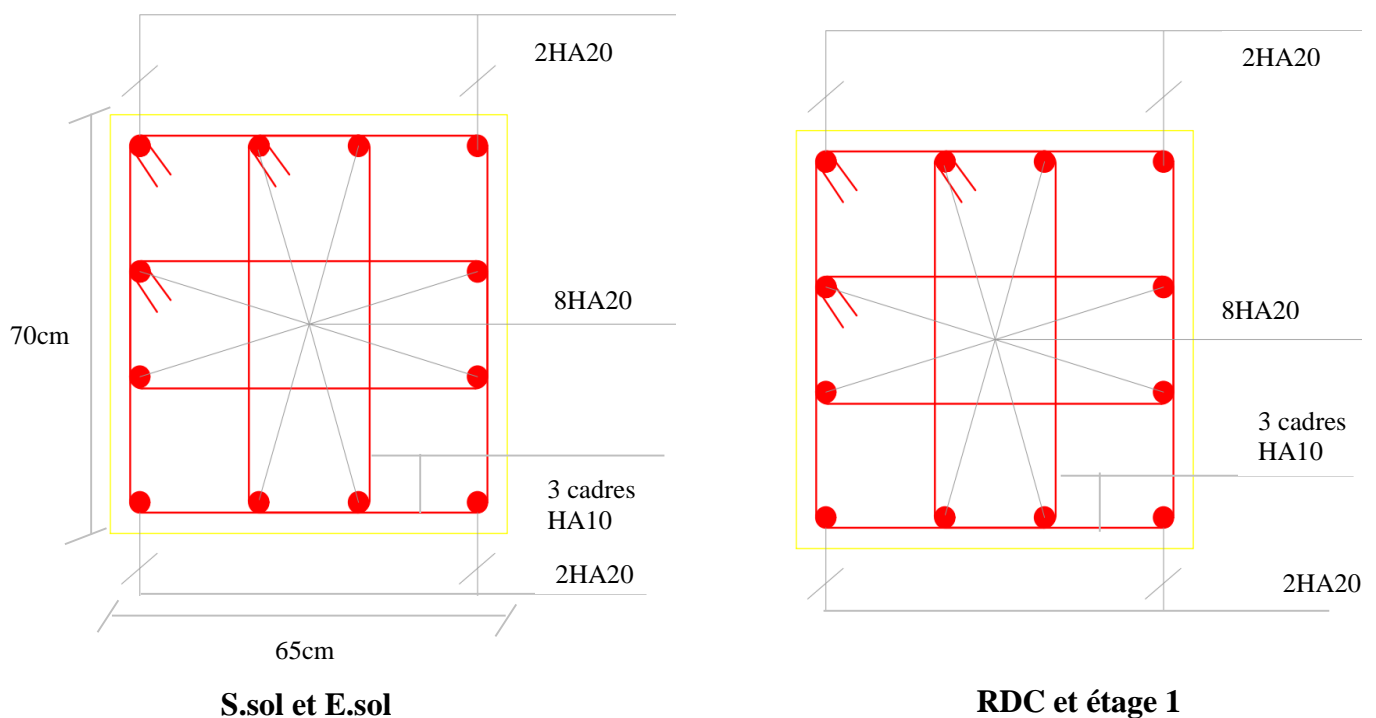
Schéma de ferrailage des poteaux de E.sol, S.sol, RDC et étage 01
